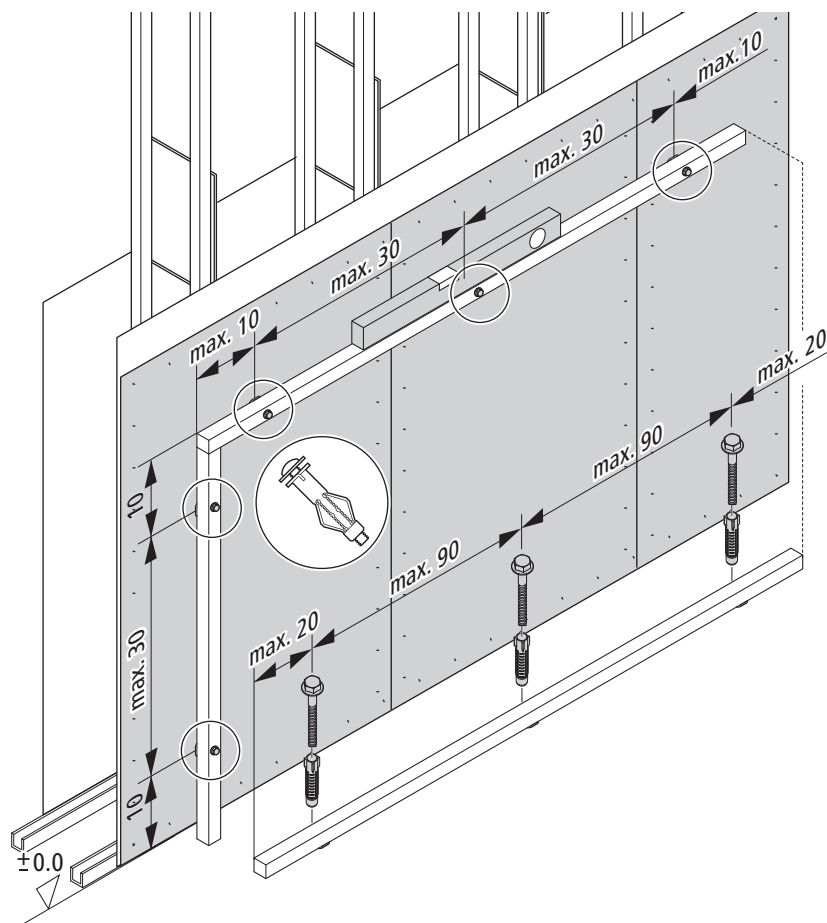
Dimensions de montage cadre de montage hauteur partielle sur paroi de construction à sec à ossature métallique (W111/W116 structure double paroi à double parement 2 × 12,5 ou 1 × 18 mm)
